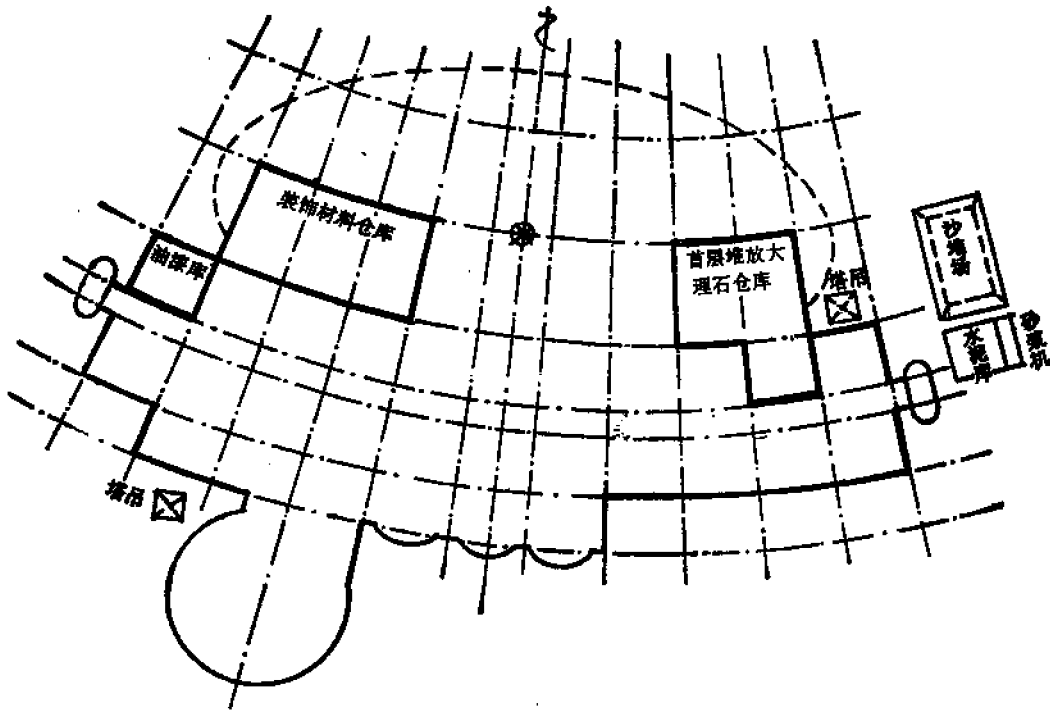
(3) 上海太平洋大饭店施工平面布置图
